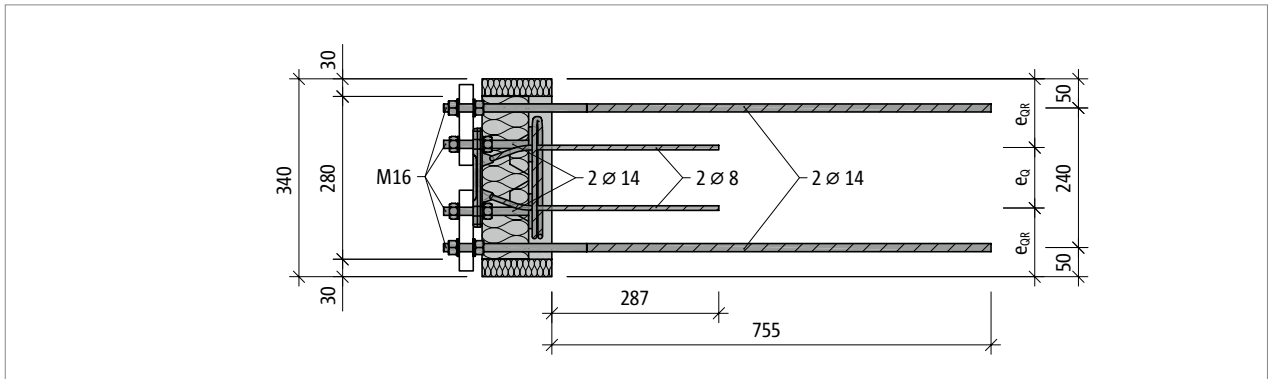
Schöck Isokorb® RT Typ SK-M2: Grundriss
